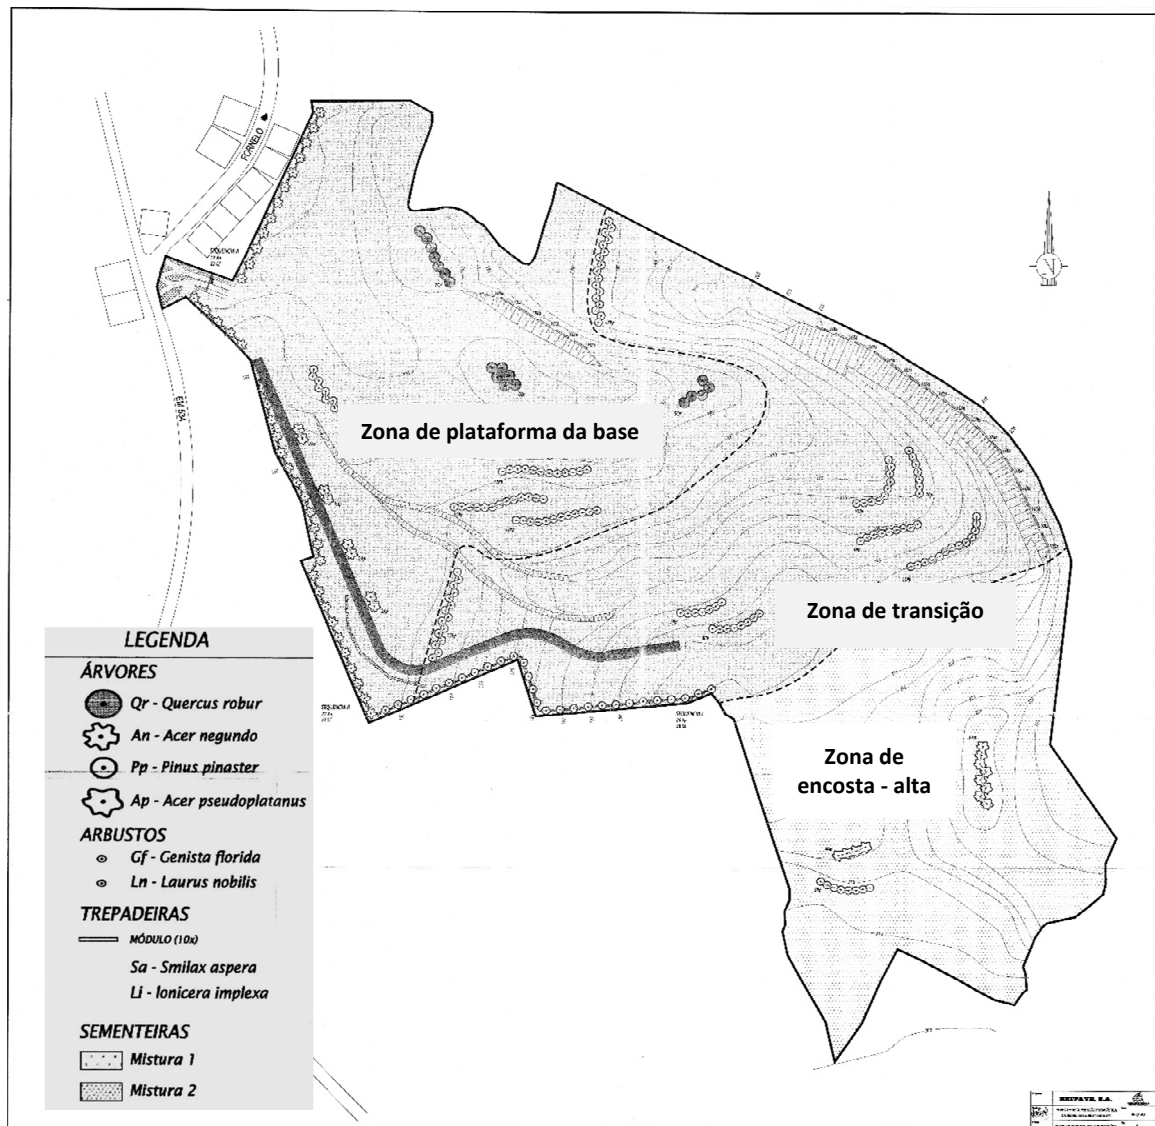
Plano de sementeiras e plantações na pedraira (adaptado de Britave *in* PARP, 2003)
